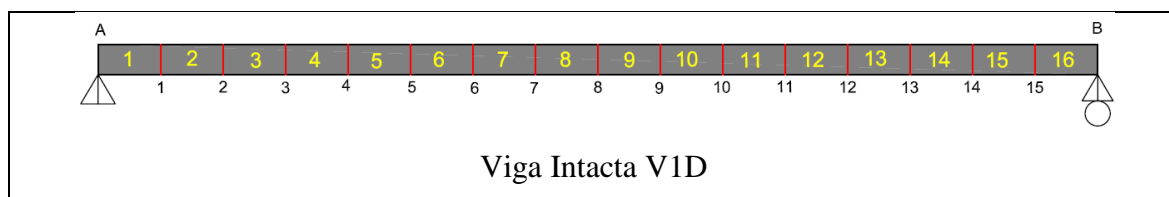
Viga Metálica Biapoiada Intacta: V1D (Palechor, 2013)
